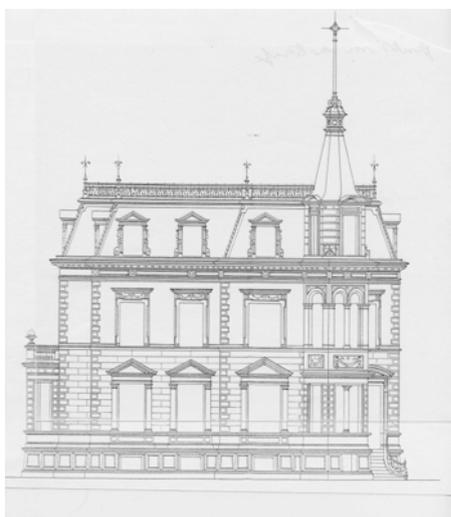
H. Plange, Aufriss der Straßenfassade, 1889
